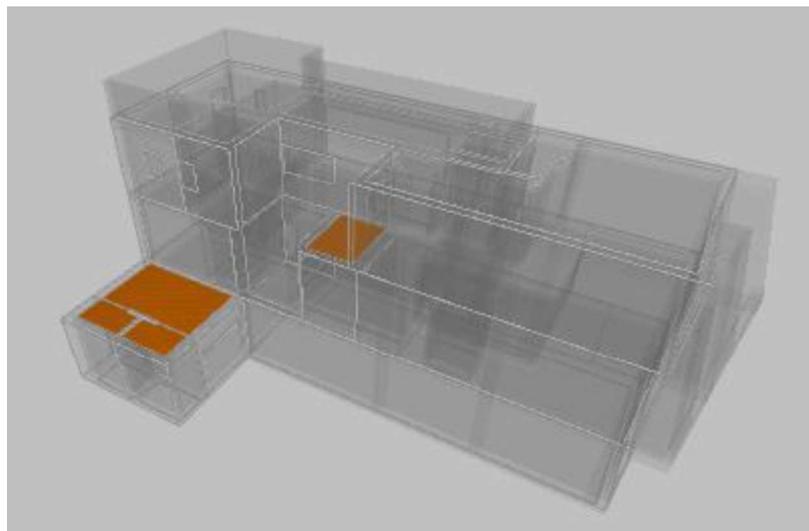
Situación de Cubiertas Extensión Planta Baja y Patio Interior en la vivienda. CYPETHERM HE Plus
